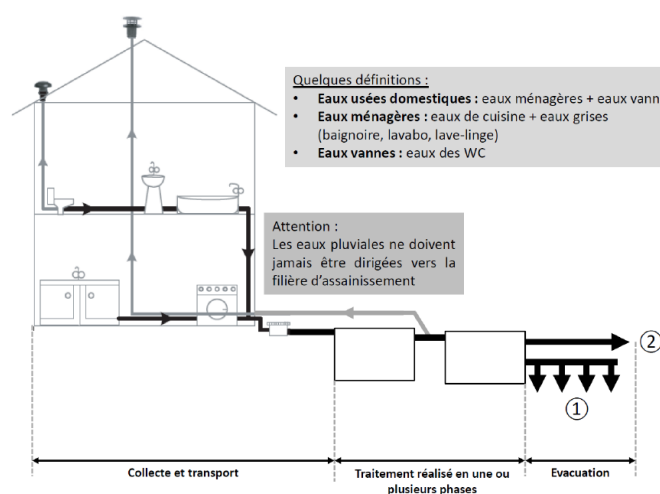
SCHEMA D'UNE INSTALLATION D'ANC
